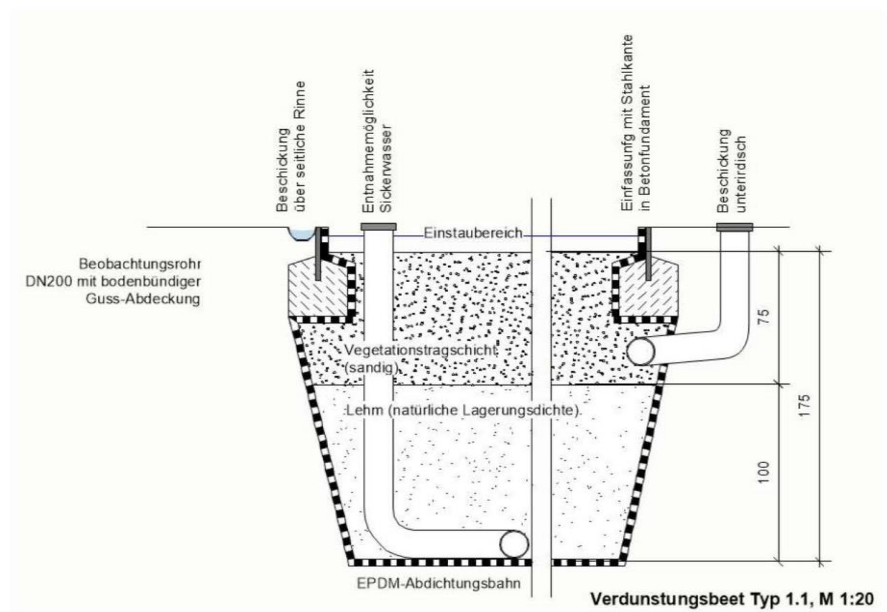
Detail Verdunstungsbeet Typ 1.1
